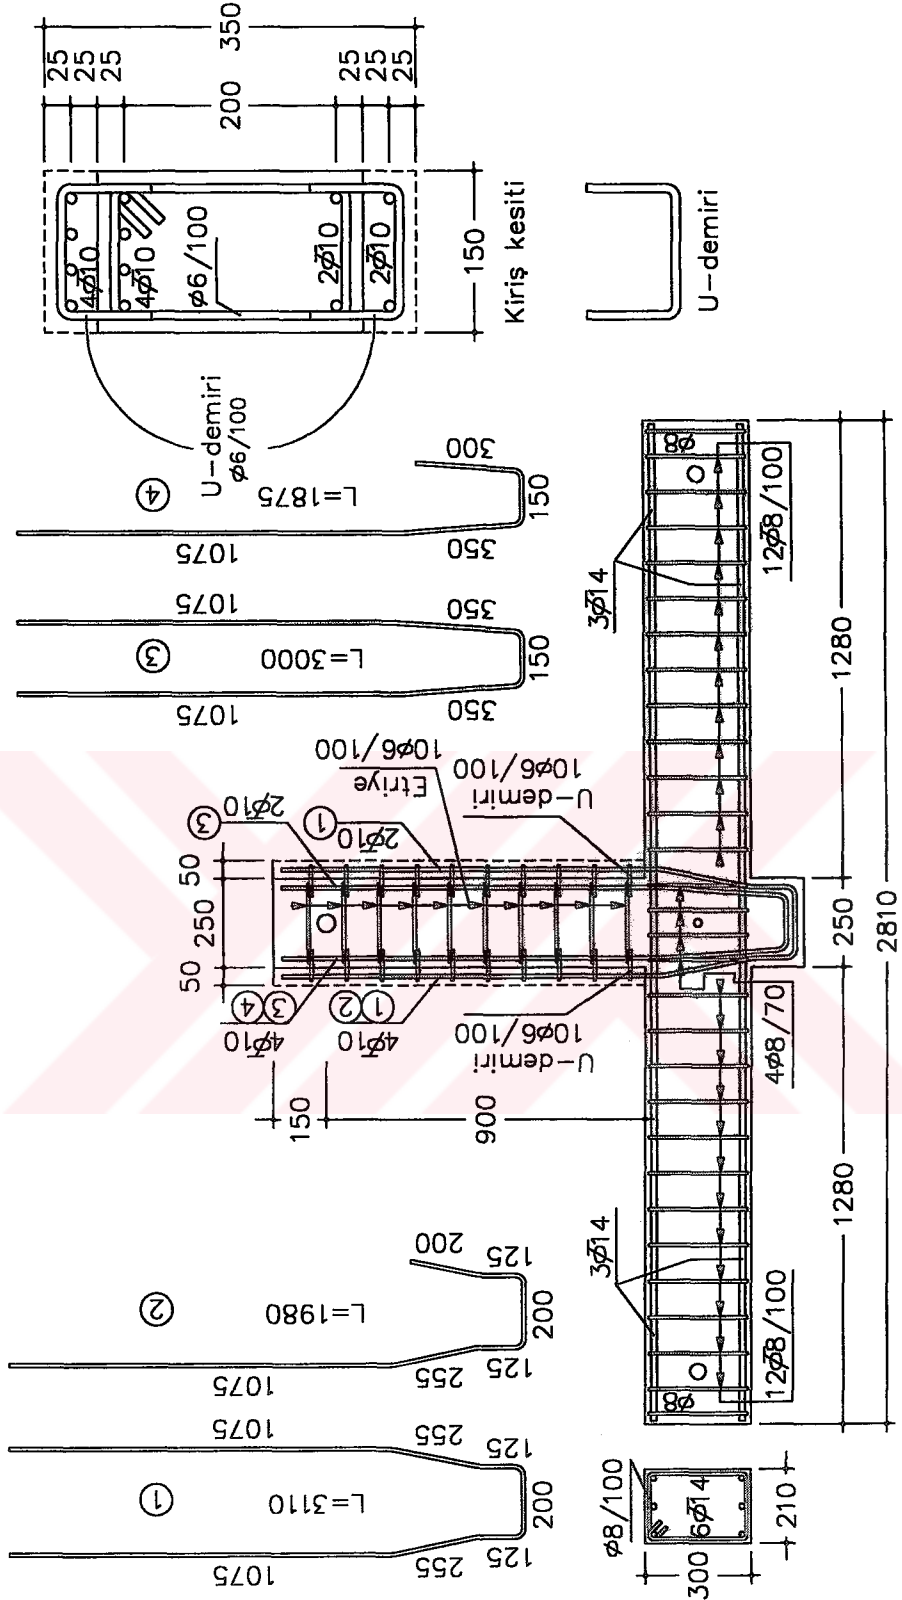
M3 elemanının boyut ve donatı detayı
